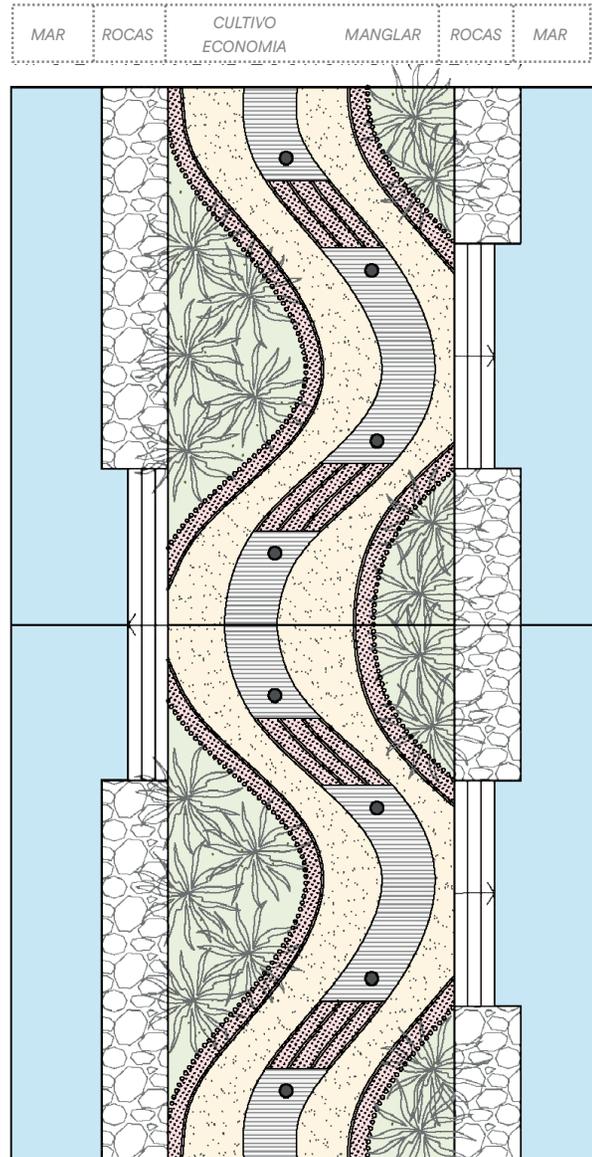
Planta modular escala 1:200 de espolón híbrido tipo B. Elaboración propia
